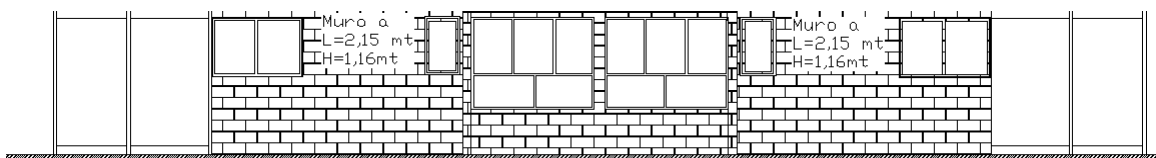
33. Fachada Eje Y, edificio 4 pisos
